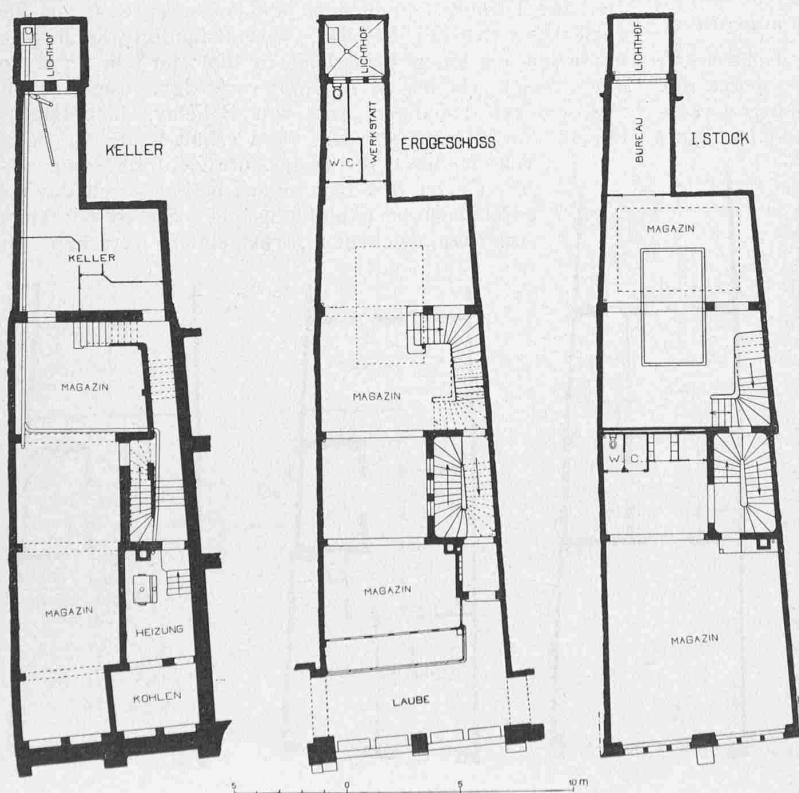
bis 3. Grundrisse des Zunfthauses. — Maßstab 1:300.
